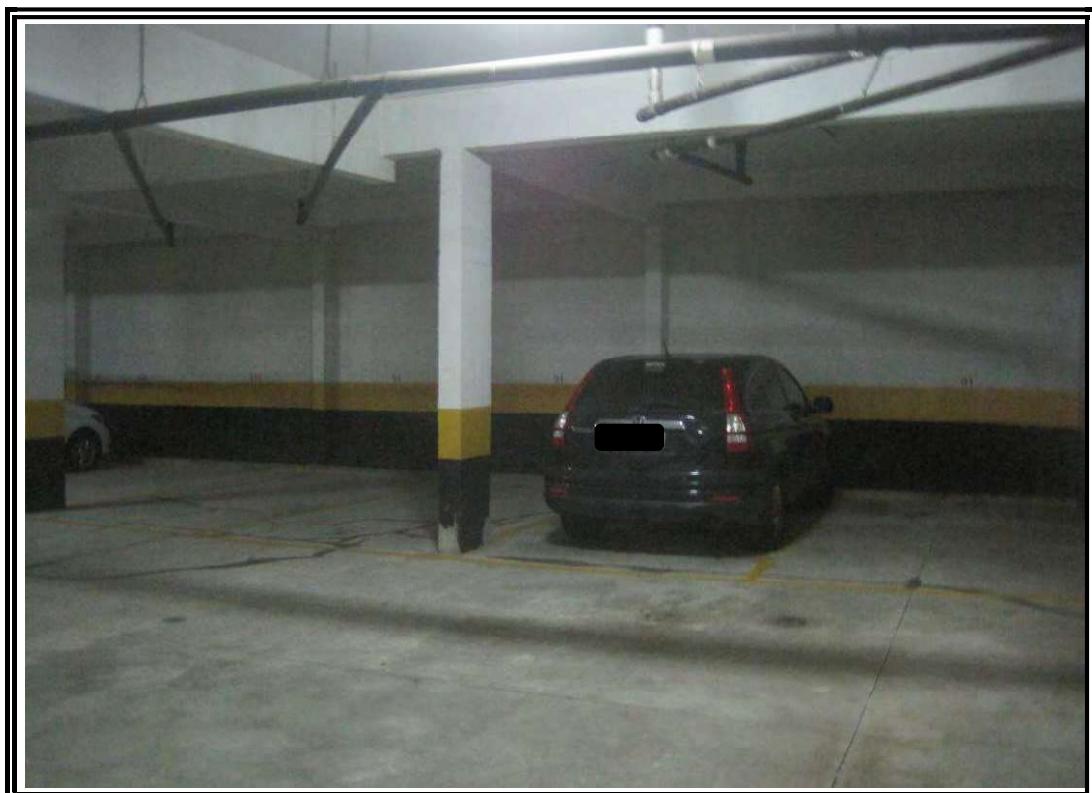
Detalhe das vagas de garagem (1º subsolo)
